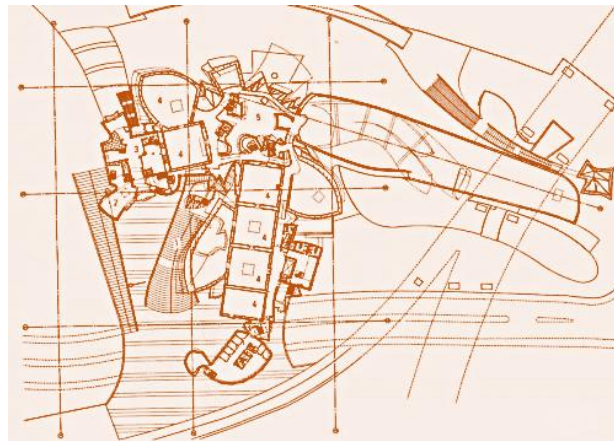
Frank Gehry, planta de accesos del Guggenheim de Bilbao. Falta de paralelismo y curvaturas en las escaleras de acceso.
